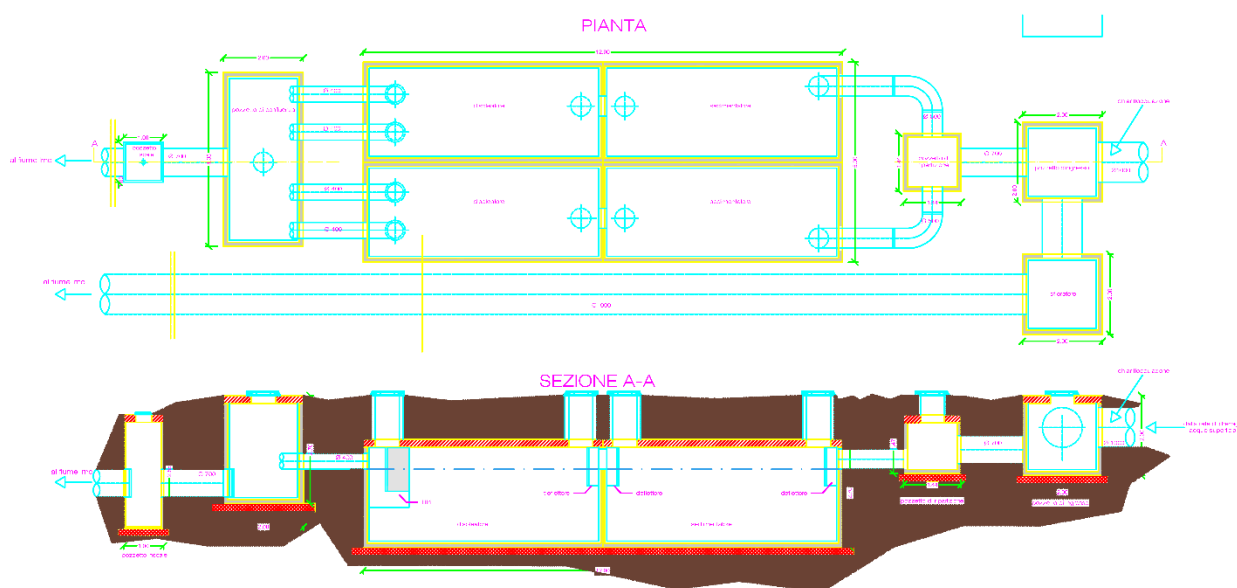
Pianta e Sezione dell'impianto di trattamento acque di prima pioggia - STATO ATTUALE
